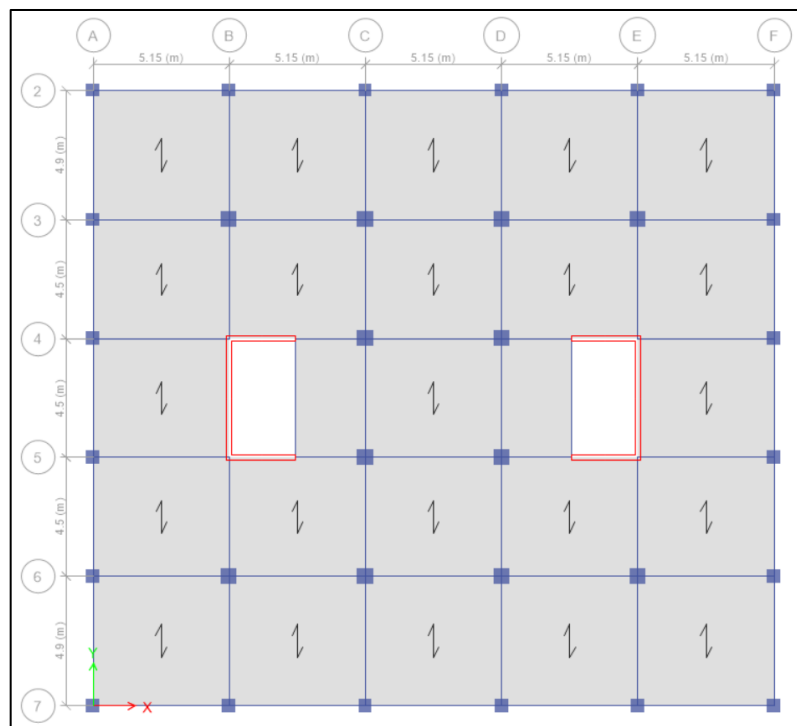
Vista en planta de la estructuración propuesta del edificio.
